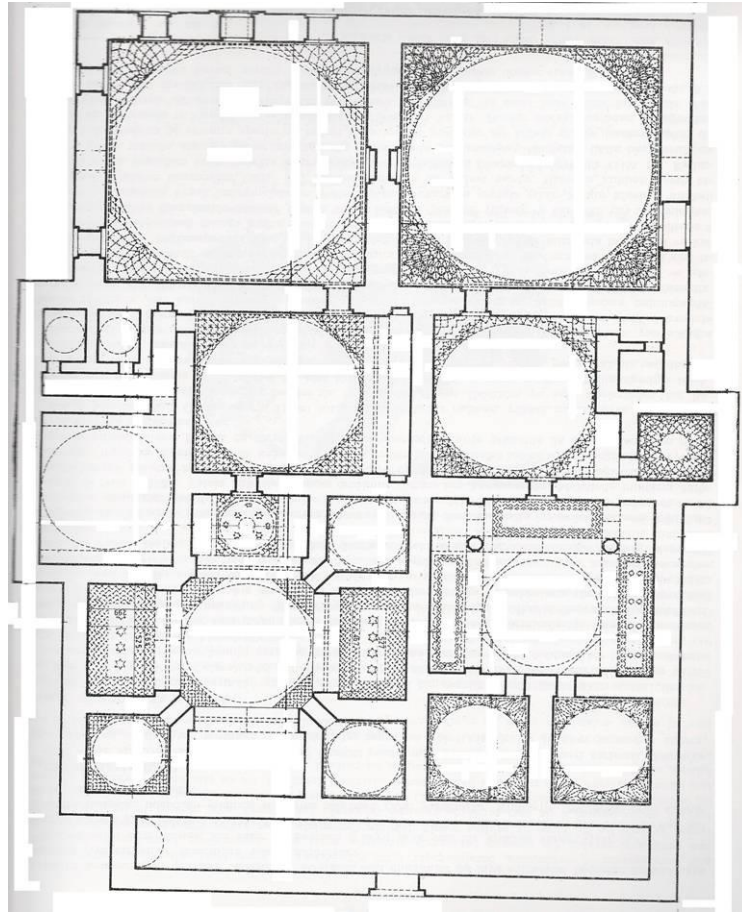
Hüsrev Kethüda Hamamı (İstanbul) plan şeması
